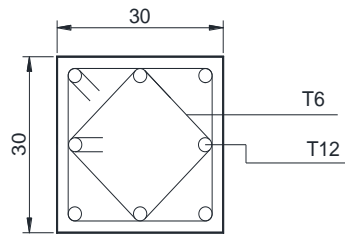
Ferrailage d'un poteau 30x30cm (poutres noyées – bâtiment R+3)
